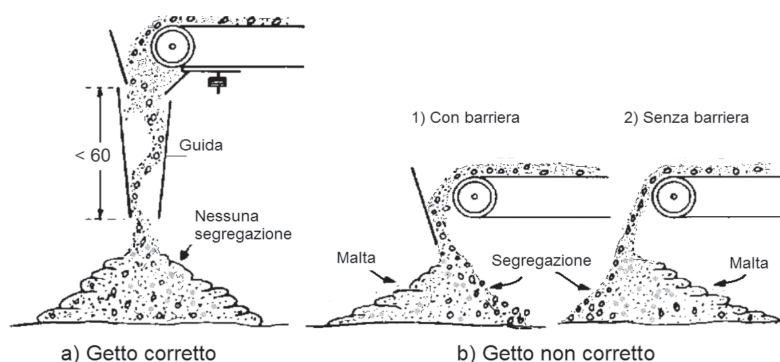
Esempi di getto di calcestruzzo con nastro trasportatore: a) getto corretto e b) getto non corretto. Nel caso b) si ha la separazione degli aggregati dalla malta cementizia. La barriera comporta soltanto il cambiamento di direzione della segregazione
